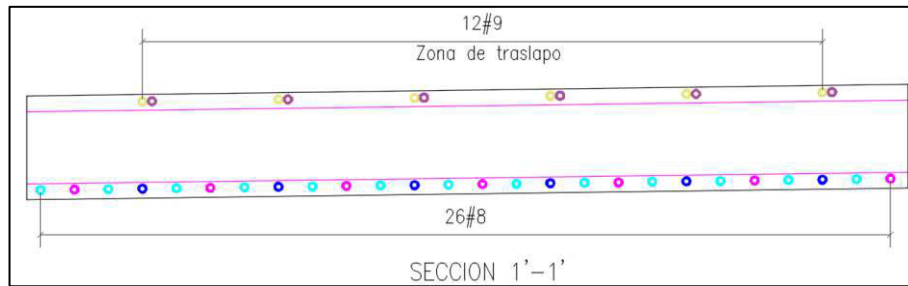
Refuerzo suministrado corte 1'-1' – FIN
